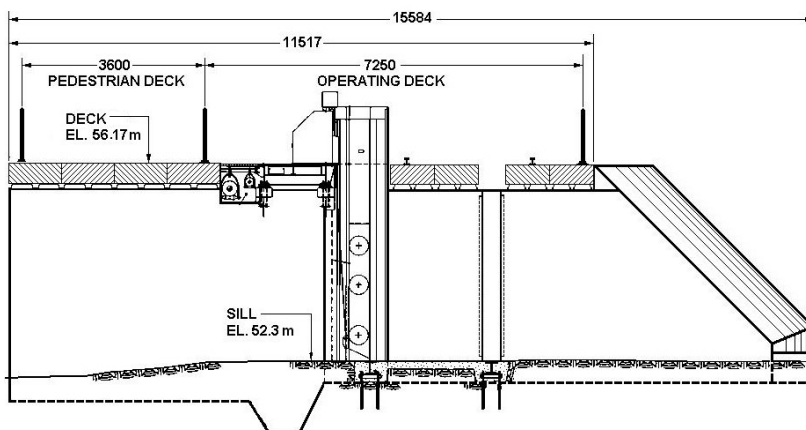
Section transversale du barrage ouest. Dimensions en millimètres.
